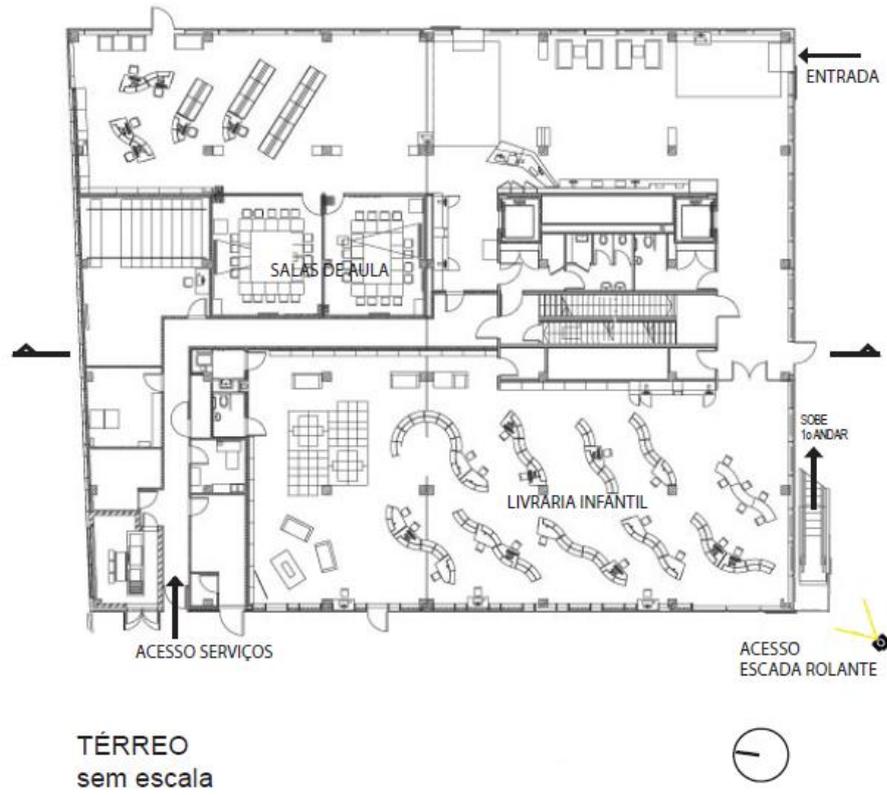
Planta do Pavimento Térreo da *Idea Store Whitechapel* (BUILDING, 2005)
